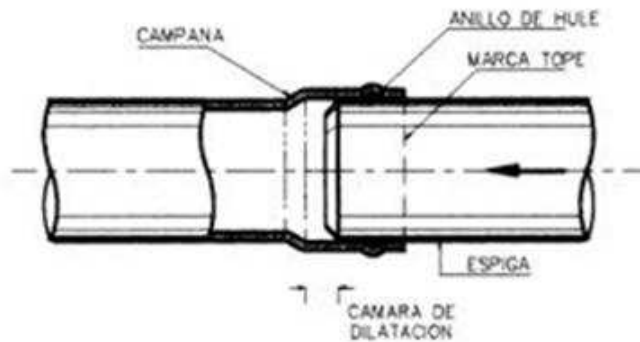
11.- UNIÓN CAMPANA-ESPIGA EN TUBERÍA DE PVC
